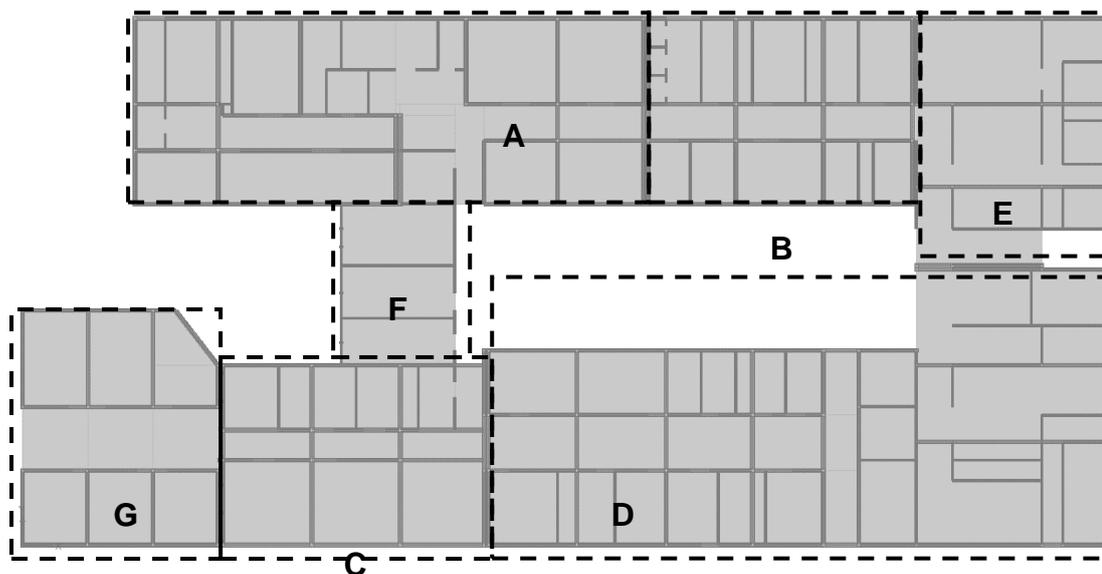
Vista en planta del modelo matemático tridimensional del Bloque 04
